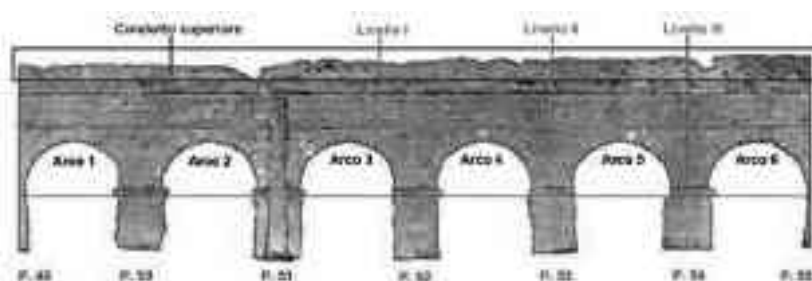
Porzione del prospetto Nord-Est interessata dall'Attività Ispettiva con indicazione dei tre livelli, dei pilastri e delle arcate
